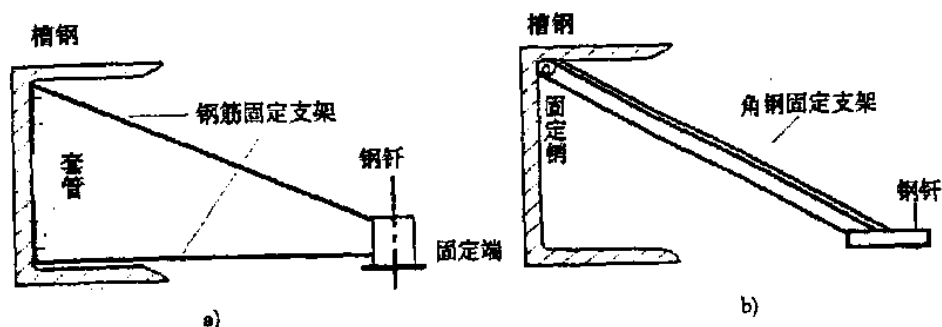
(槽)钢模板焊接钢筋或角钢固定示意图
